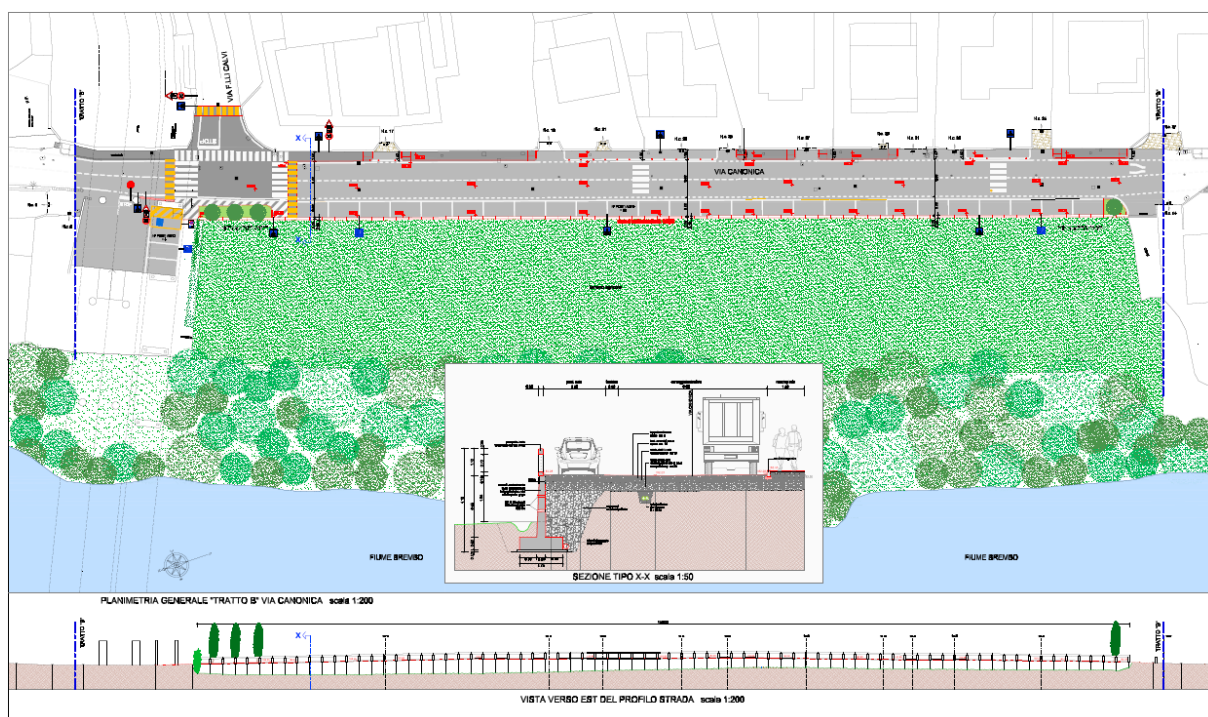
Stralcio della tavola 3 di progetto: planimetria generale di progetto con segnaletica stradale, vista del profilo strada e sezione tipo.
